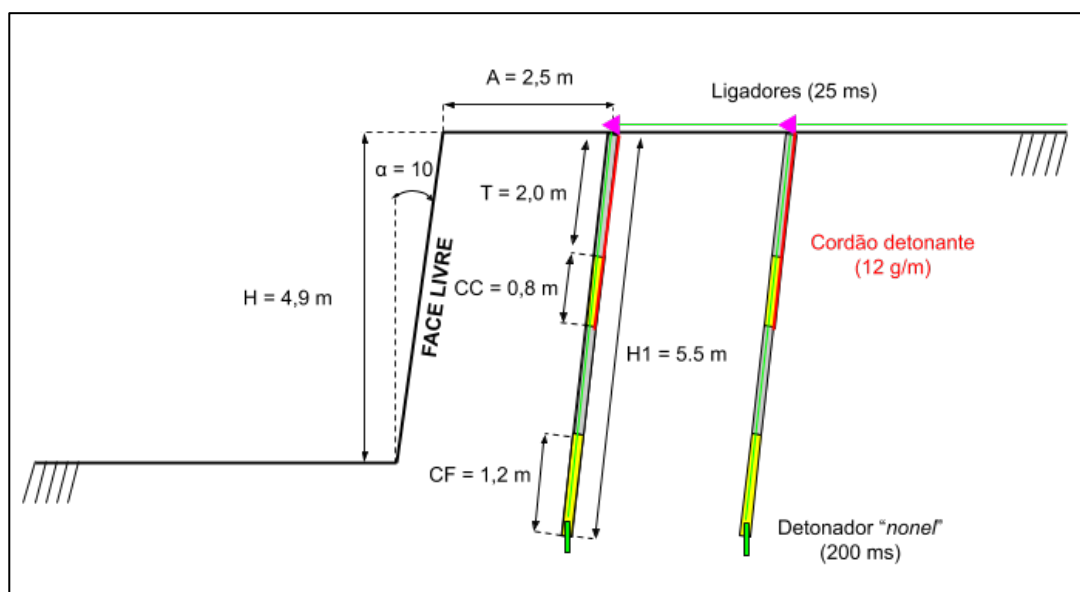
Secção de um furo da mina de "Faraona" (adaptado de Cardu & Giraudi, 2009)
